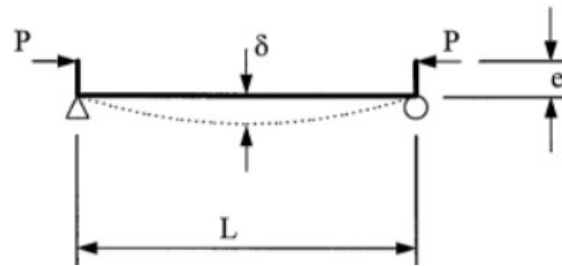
Схема испытания стержней из трубобетона в работах Расселла Бриджа [75]
